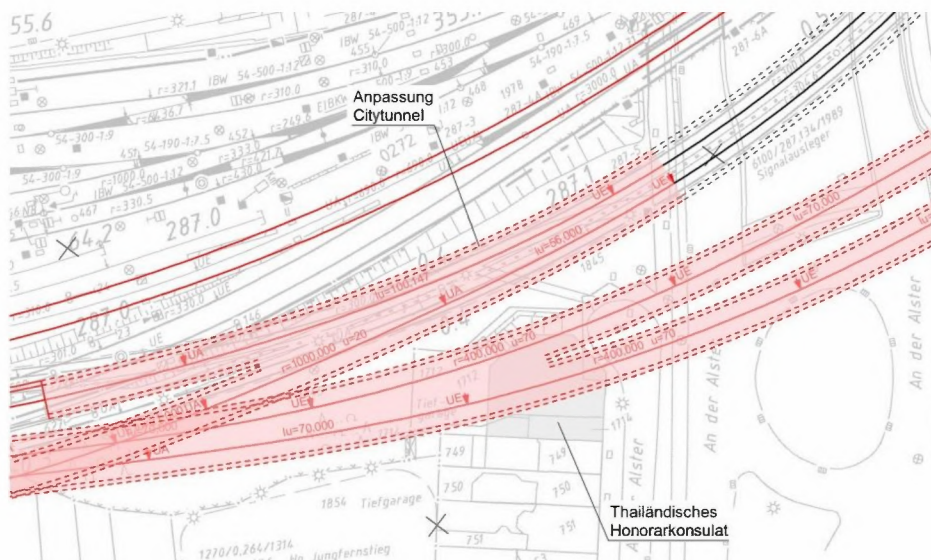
Lageplan Variante 2 – Anpassung City-Tunnel
